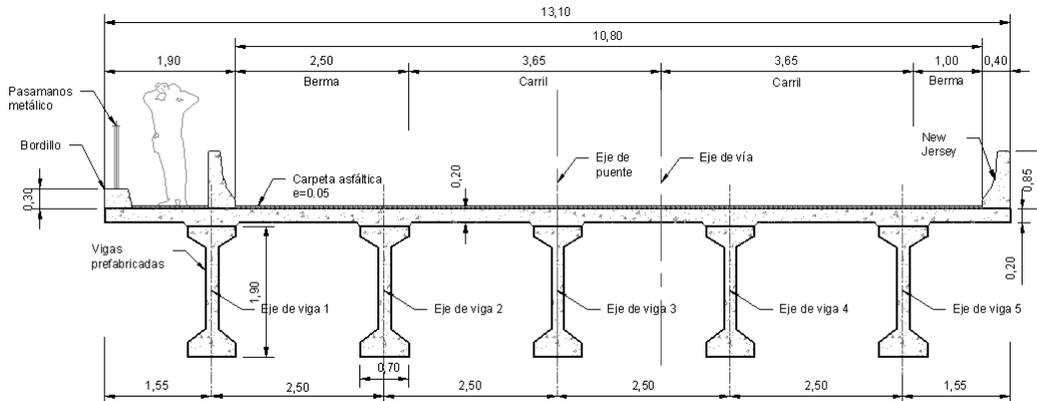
Sección transversal puente con vigas en concreto puente Sogamoso
